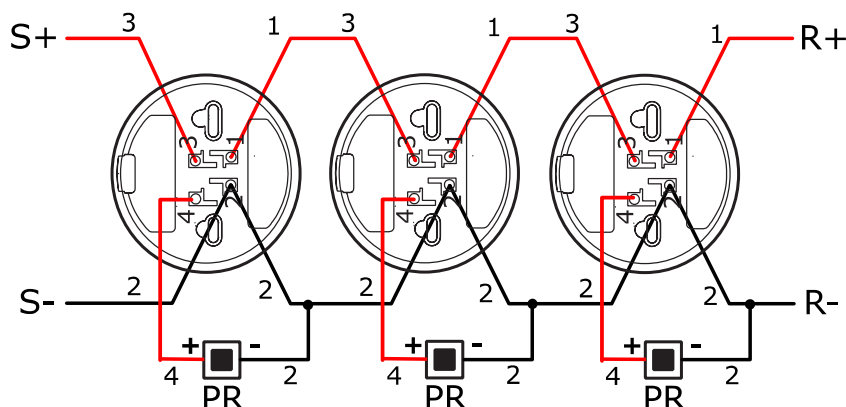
Collegamento dei rilevatori con la spia luminosa di indicazione dell'azione
